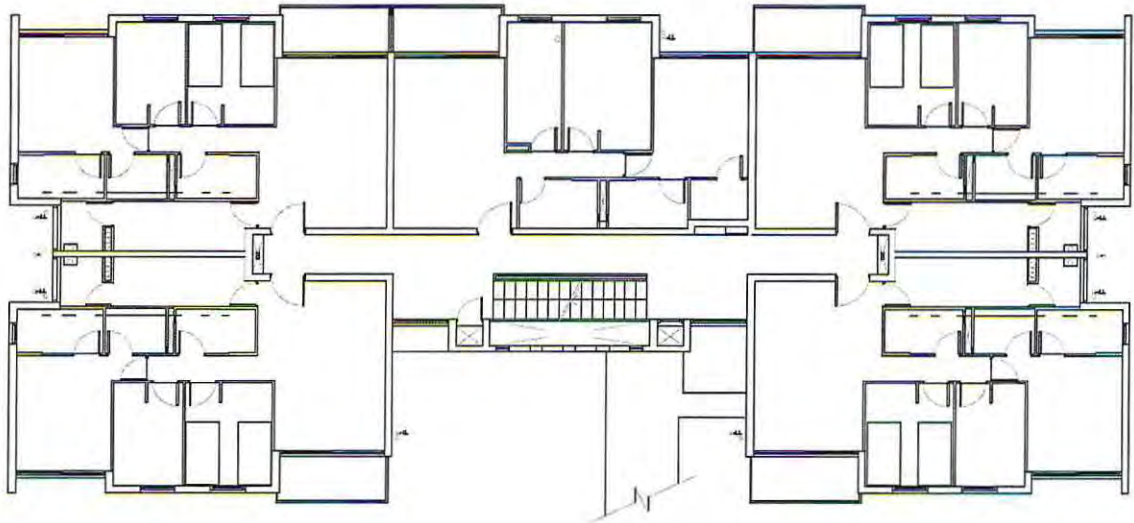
Planta esquemática edificio Kandinsky (Concón).
